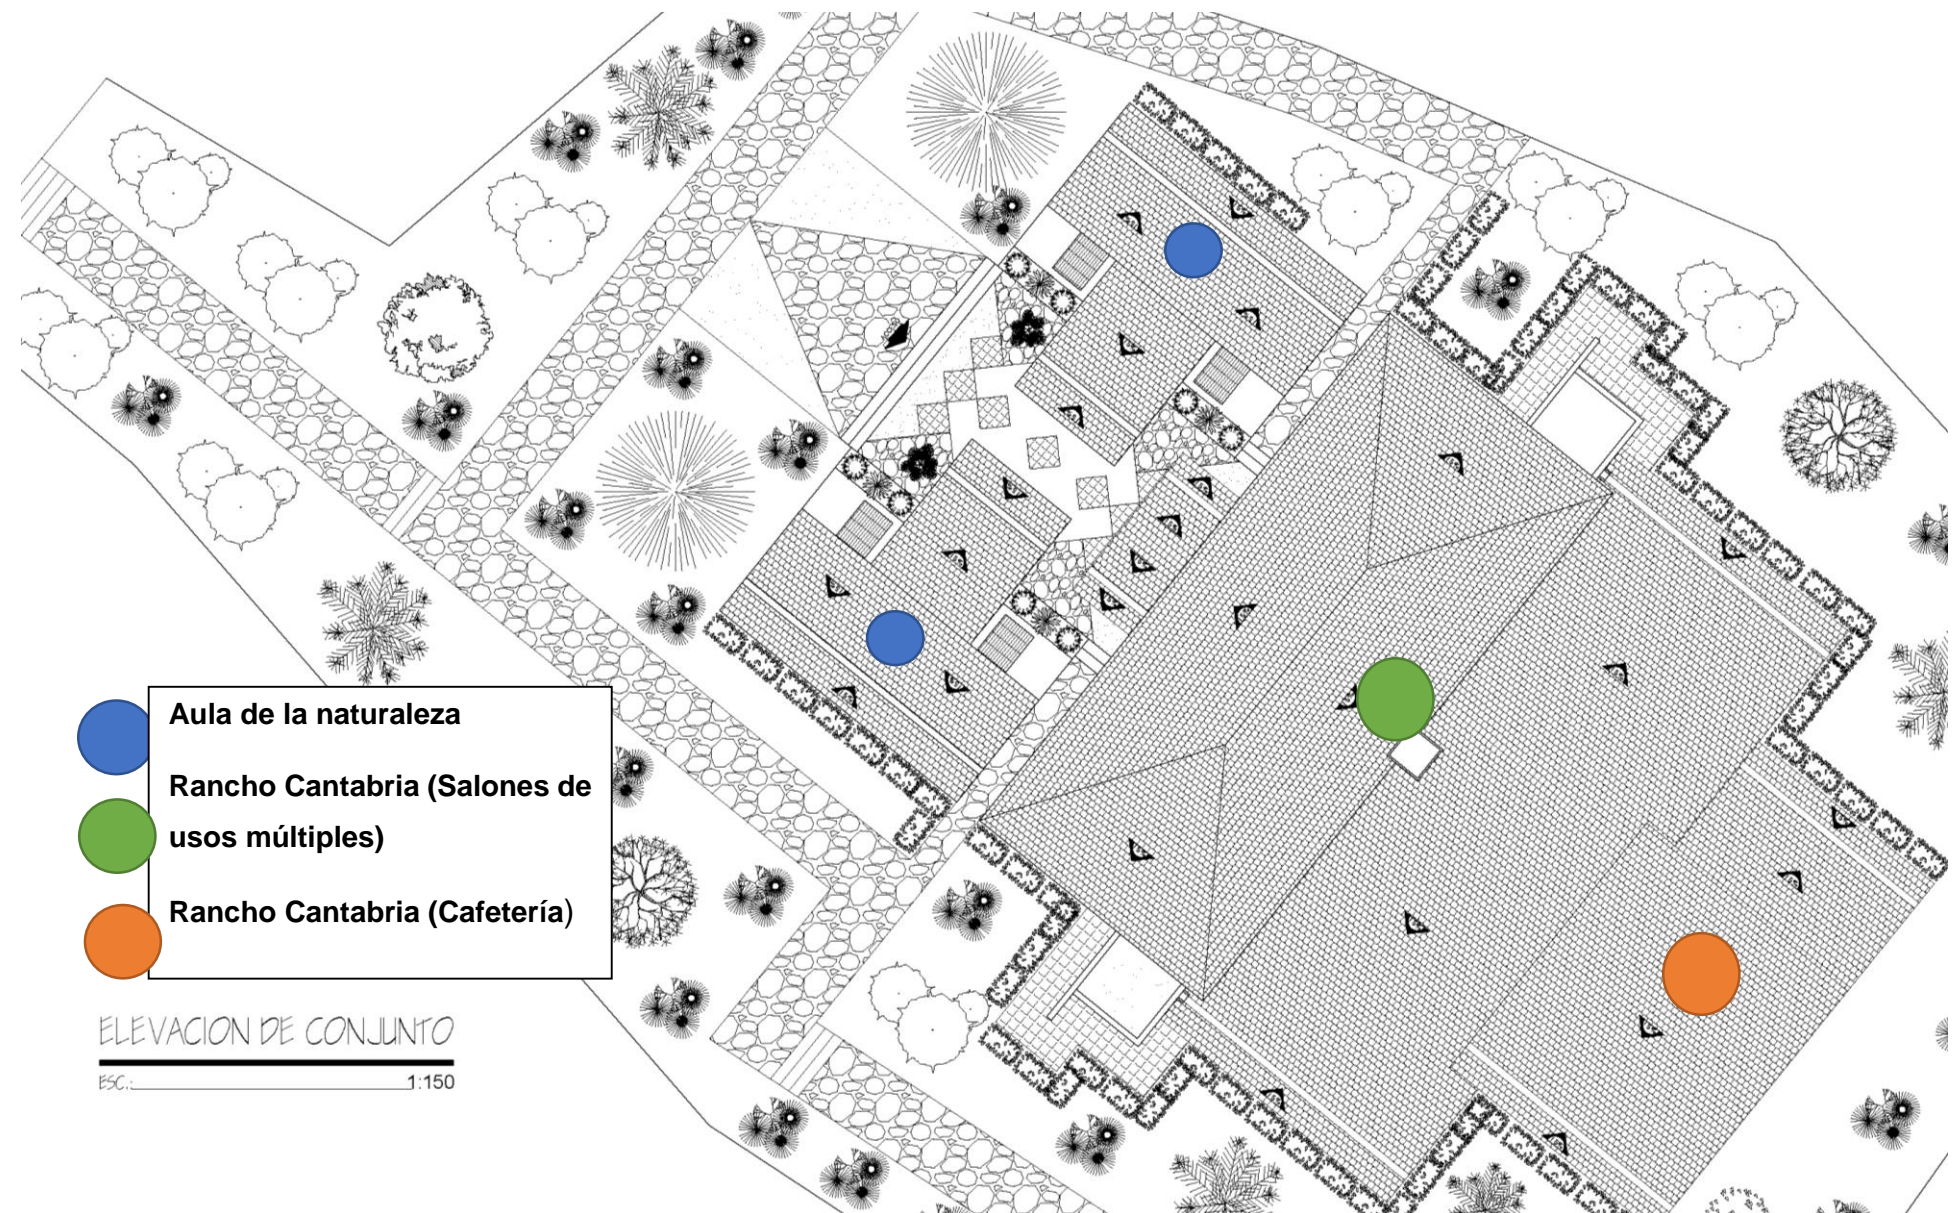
Planta de techo Rancho Cantabria. Finca las Delicias
